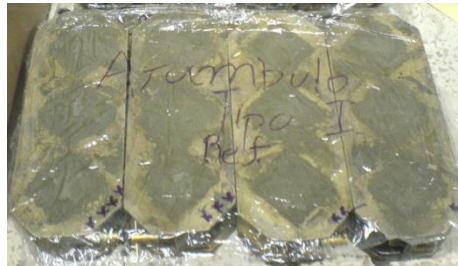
PROBETAS CUBIERTAS CON UN PLÁSTICO
